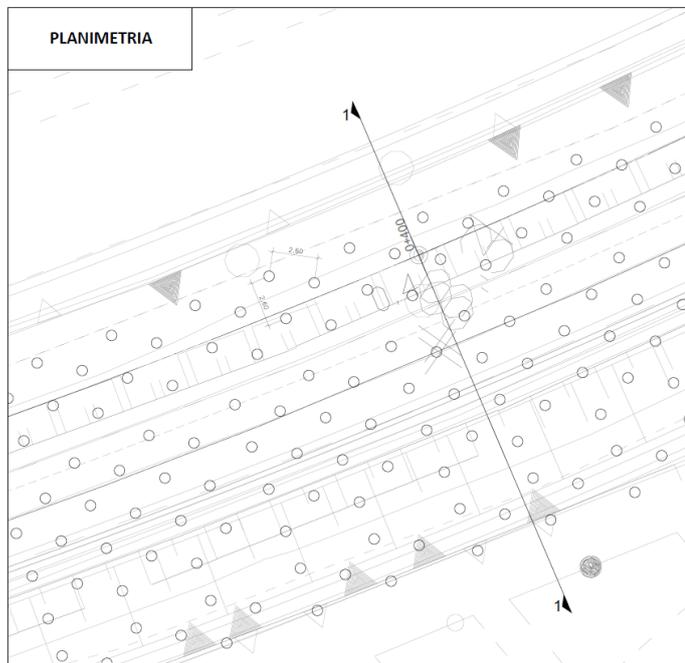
Sezione rappresentativa tratta tratte 0+000 – 0+600 e 1+050 – 1+250 - planimetria
